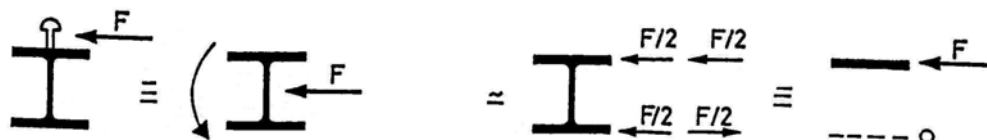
Reprise par cisaillement et flexion des ailes de la poutre transversale des sollicitations des connecteurs disposés sur cette poutre.
